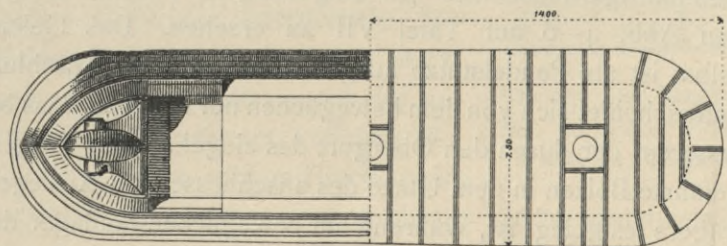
Grundriss eines Strompfeilers. 1 : 300.
